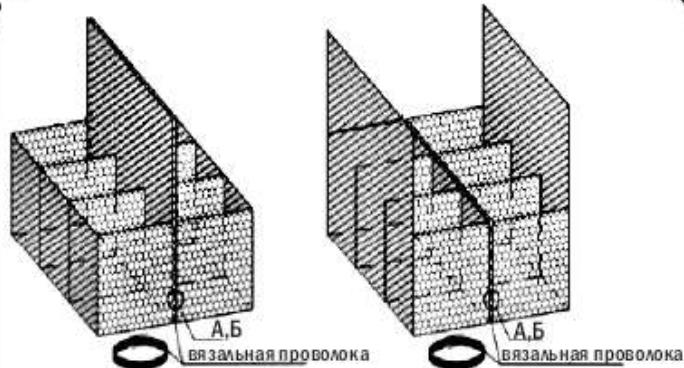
Связка двух коробчатых габионных конструкций
